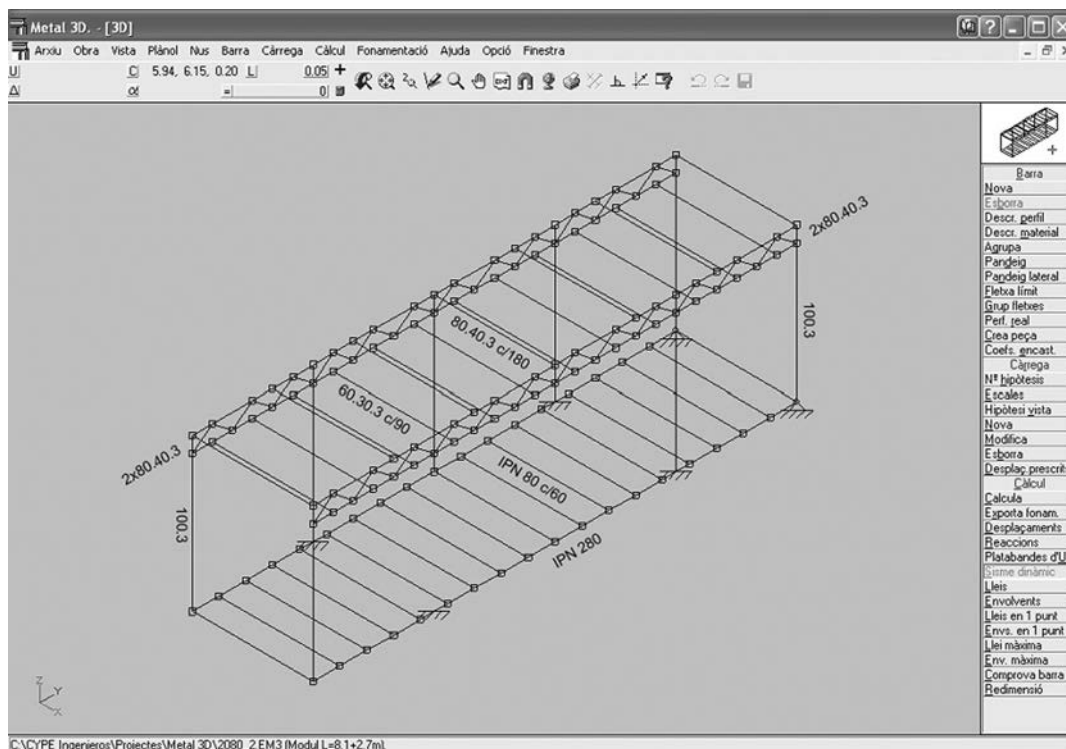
Esquema tridimensional de cálculo de un módulo metálico prefabricado.
